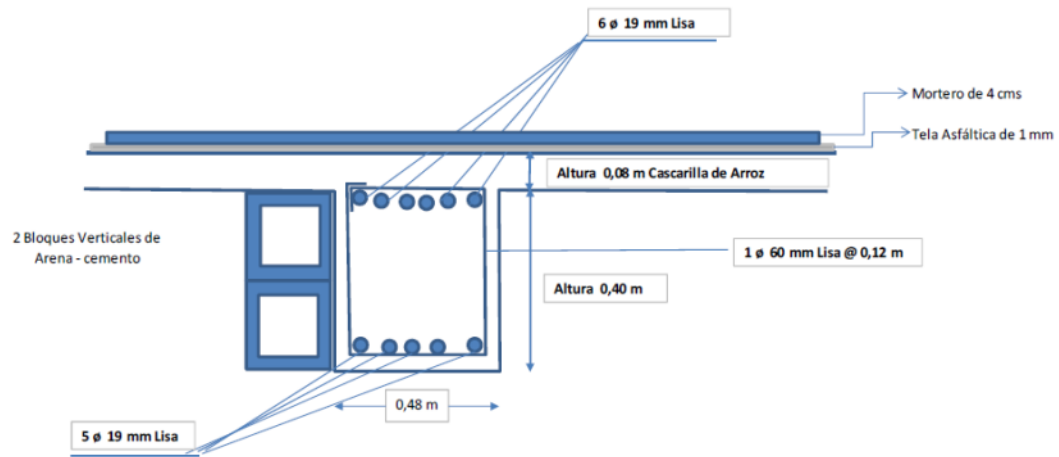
Viga B entre Ejes 5-6 Tercer Piso Segunda Placa
